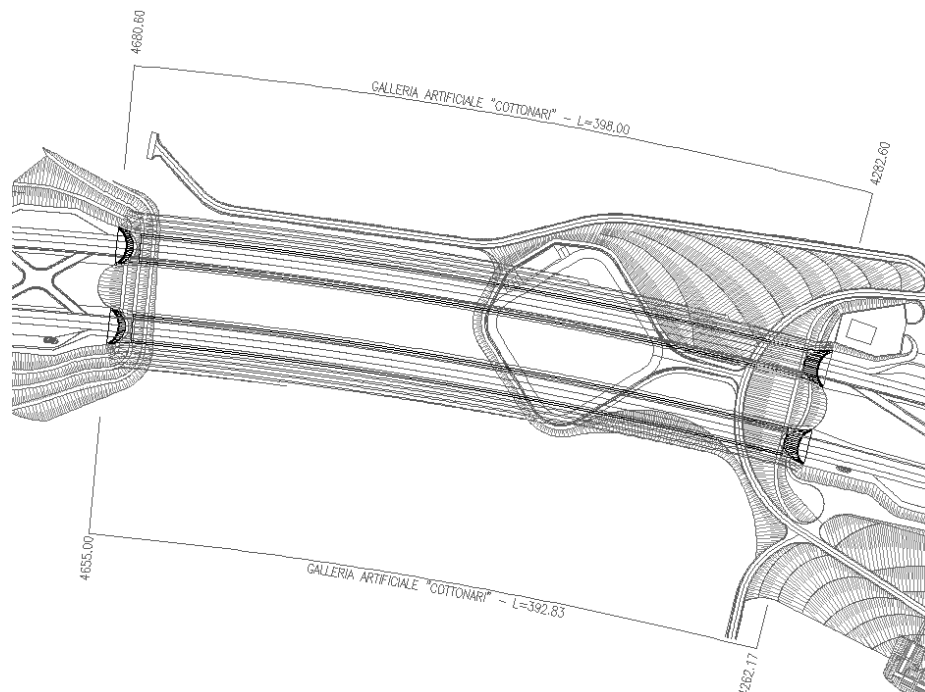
Planimetria Op.33 "Galleria Cottonari"
